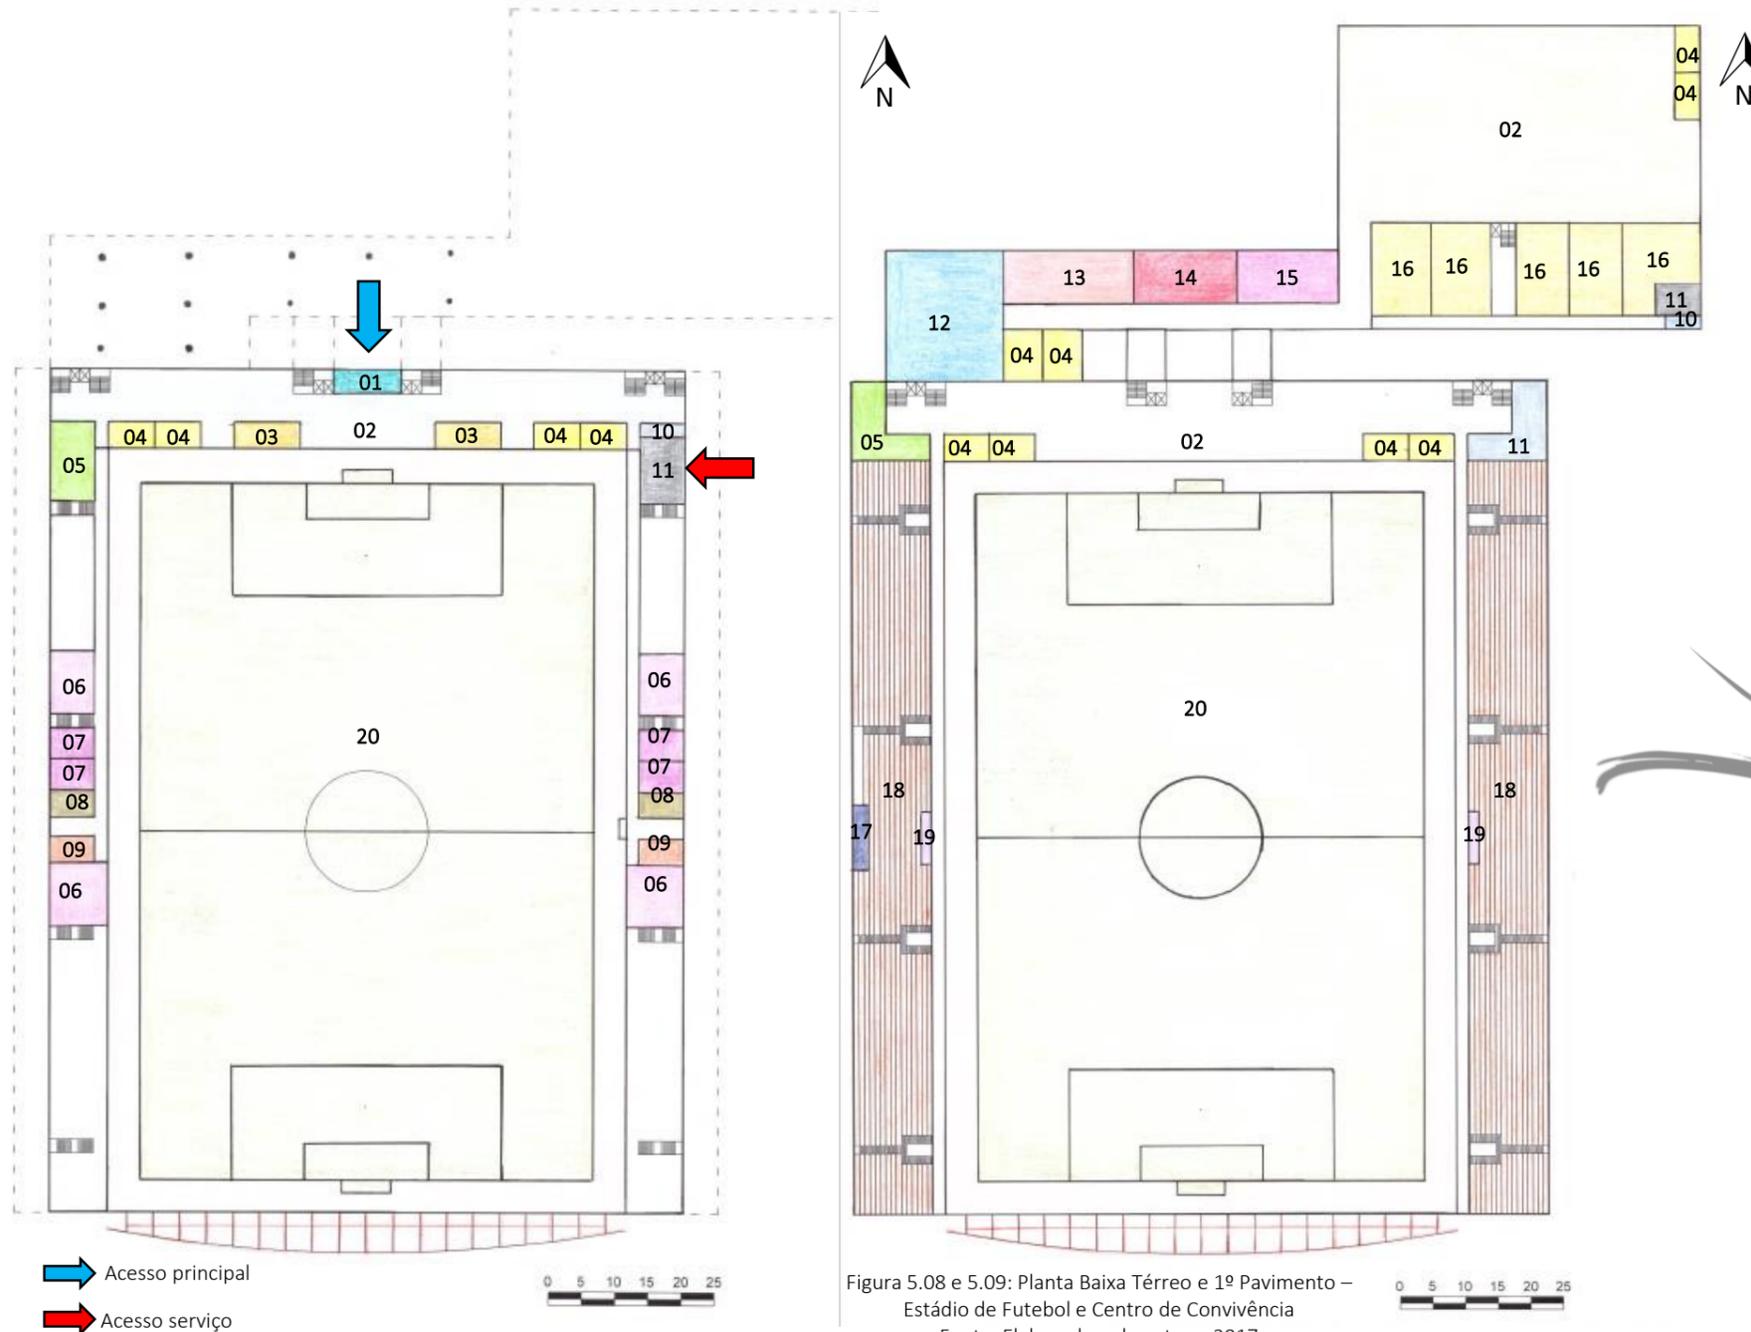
e 5.09: Planta Baixa Térreo e 1º Pavimento – Estádio de Futebol e Centro de Convivência
